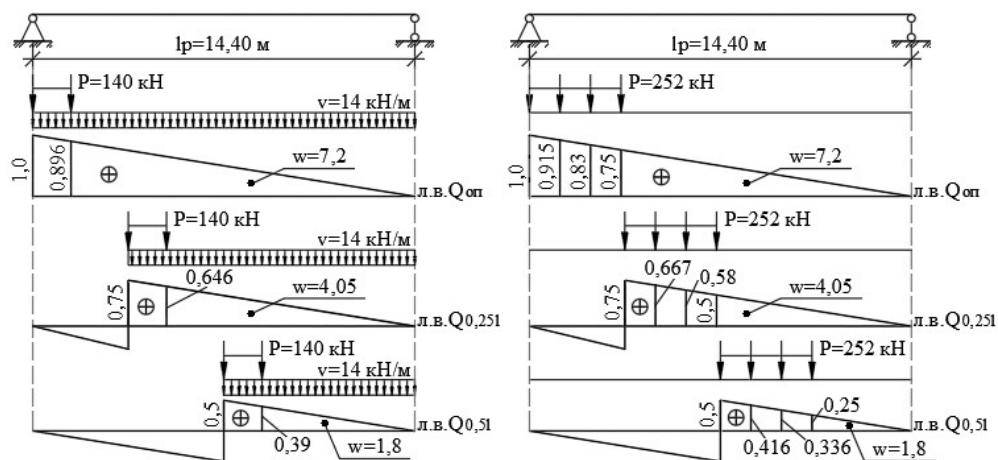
Схемы загрузки линий влияния поперечных сил отдельной балки временными нагрузками А14 и Н14
